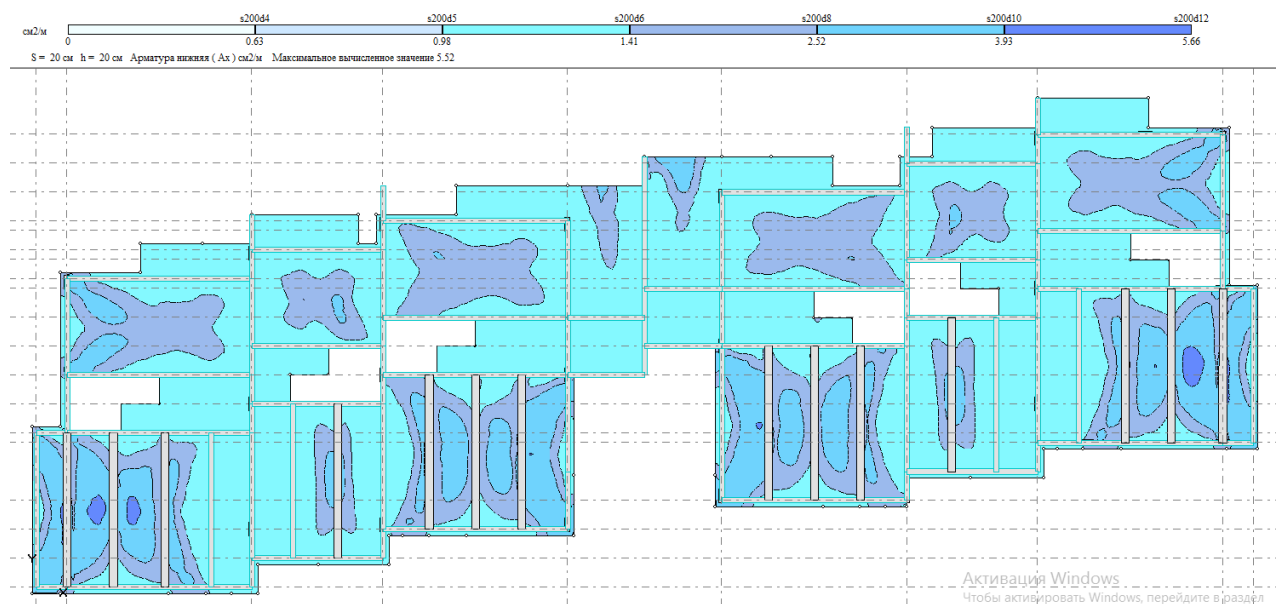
Нижня арматура плити перекриття на відм. 0.000 у напрямку осі X (A_x)
